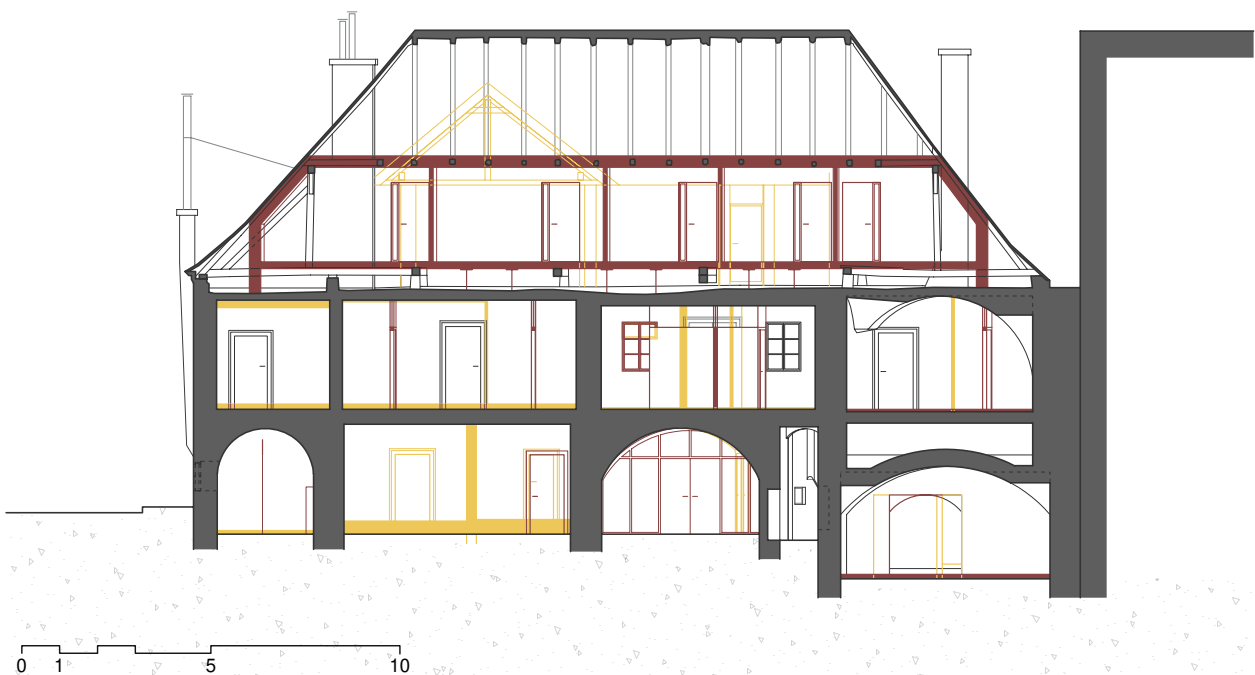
Bauliche Eingriffe Schnitt A-A M 1:200
